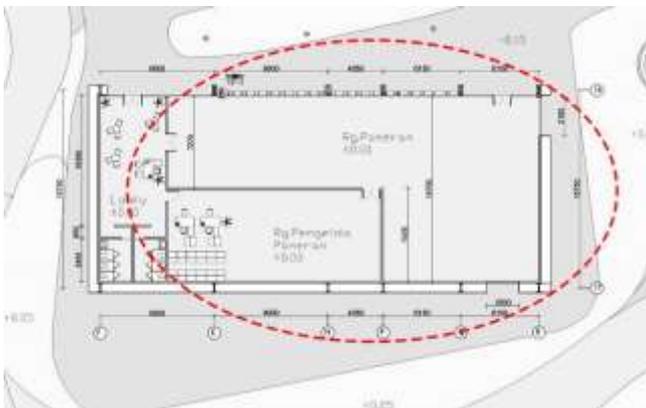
Denah Lantai 1 Entrance Hall
